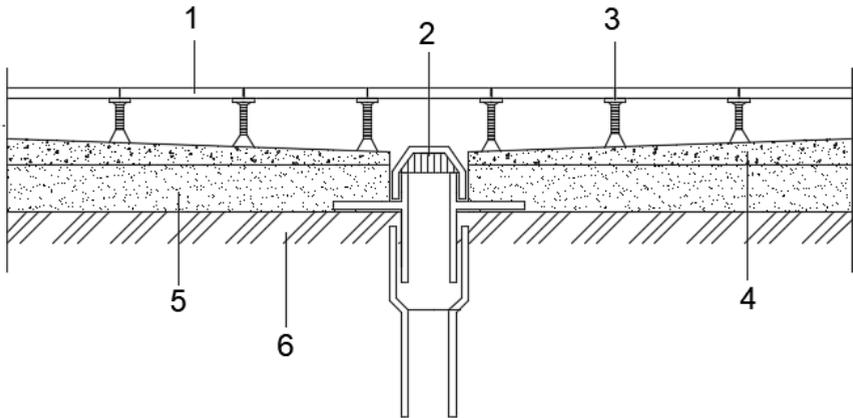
Detalla encuentro pavimento con sumidero. Fuente: Propia de la autora
